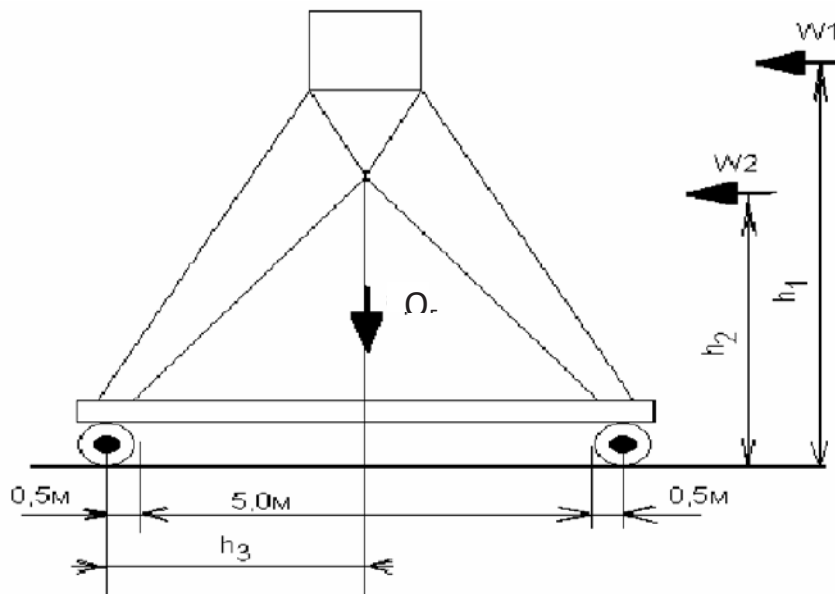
Расчетная схема грузовой устойчивости козлового крана
